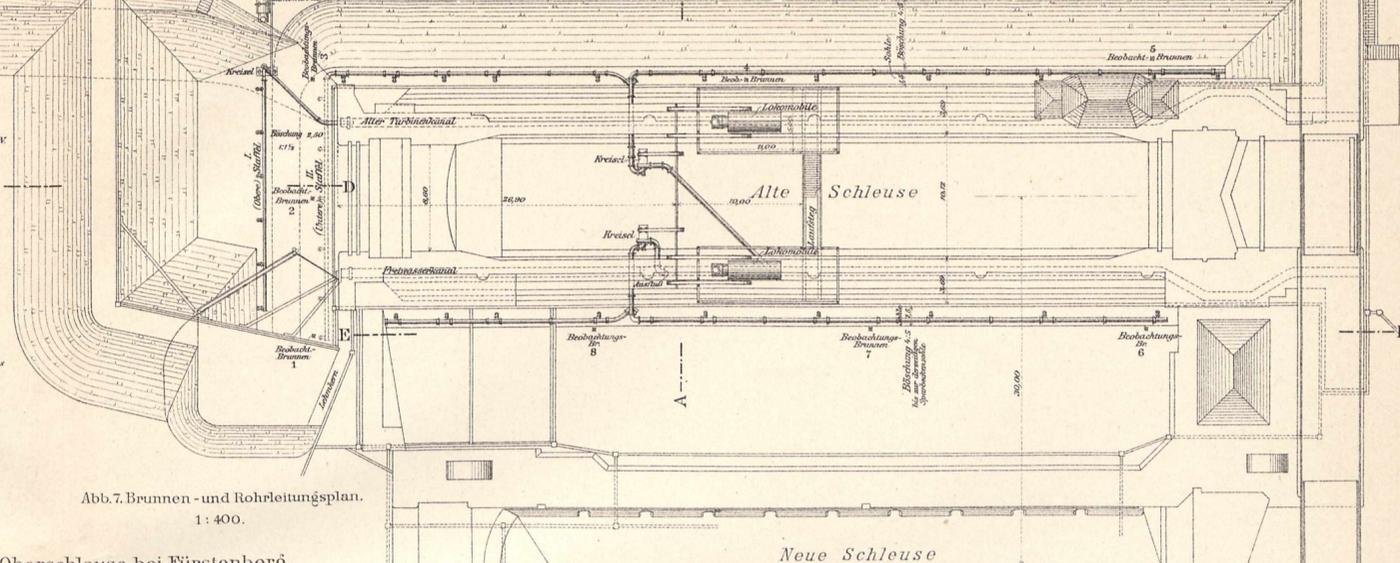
Brunnen- und Rohrleitungsplan. 1: 400.
